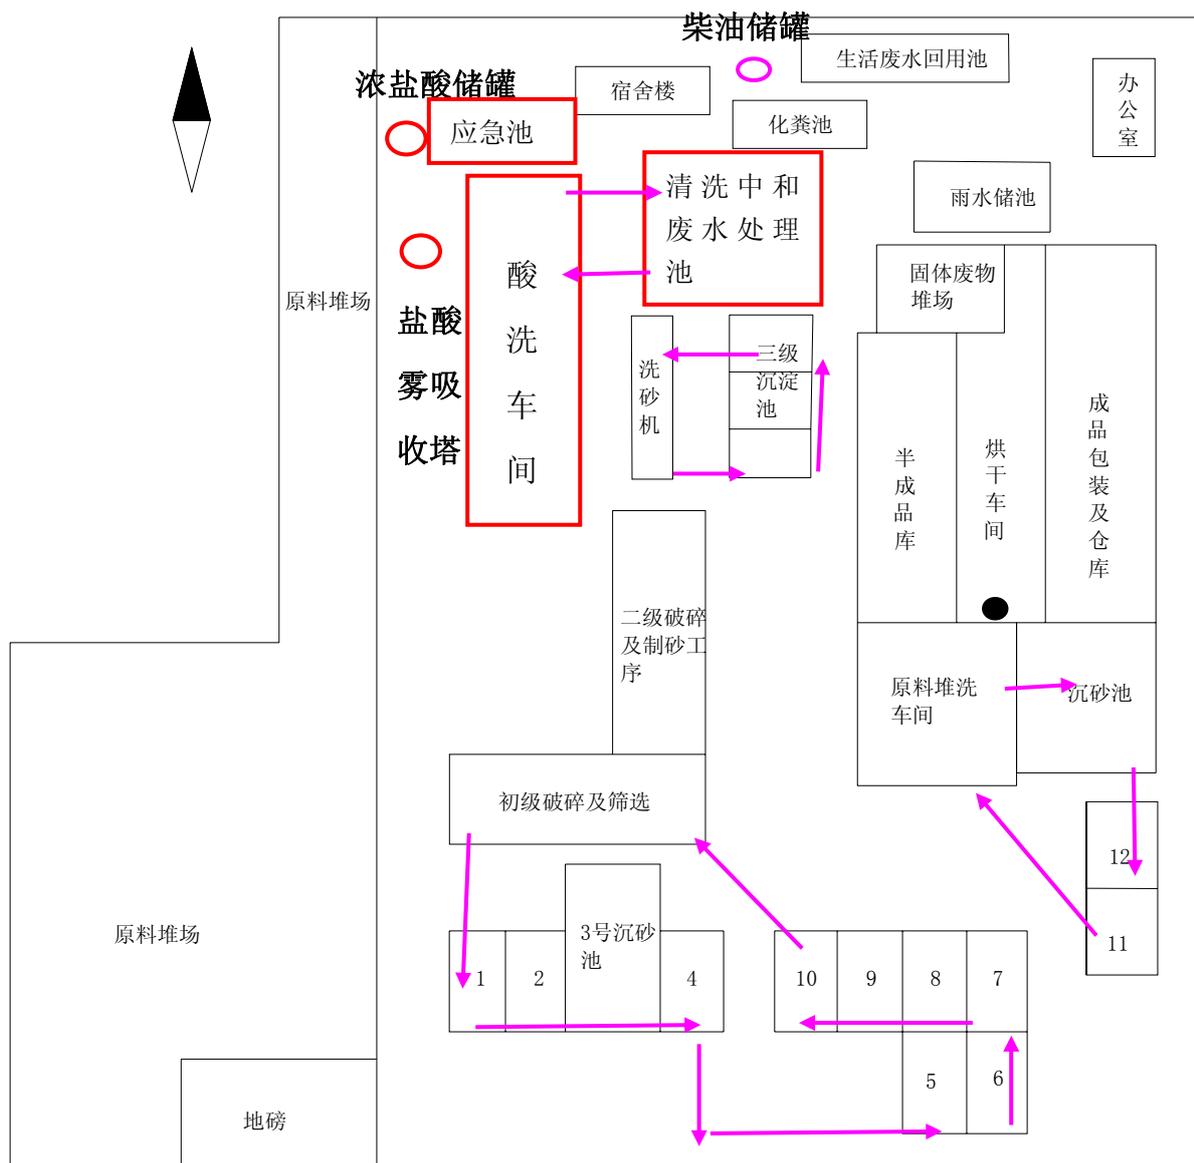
扩建后全厂的总平面布置图 ● 烘干工序废气排放口
